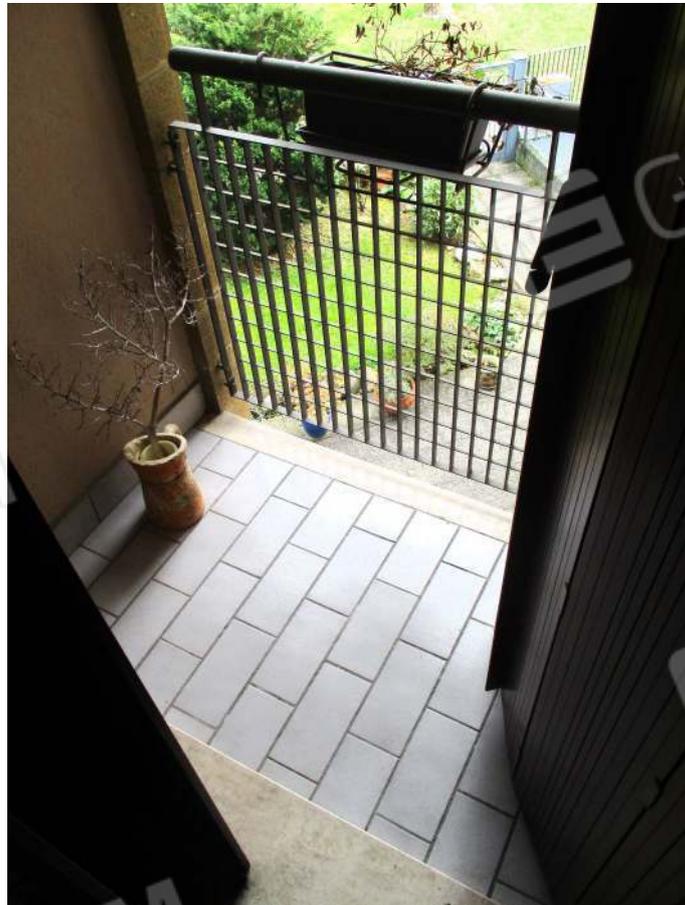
Vista del balconcino della seconda camera (lato est)
